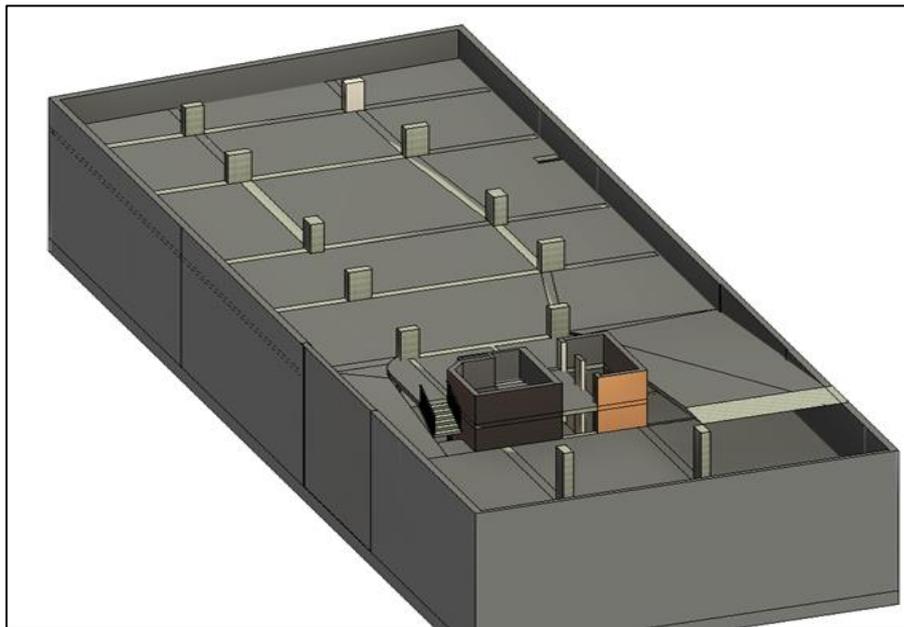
Modelamiento de columnas, losas y muros de sótanos.
